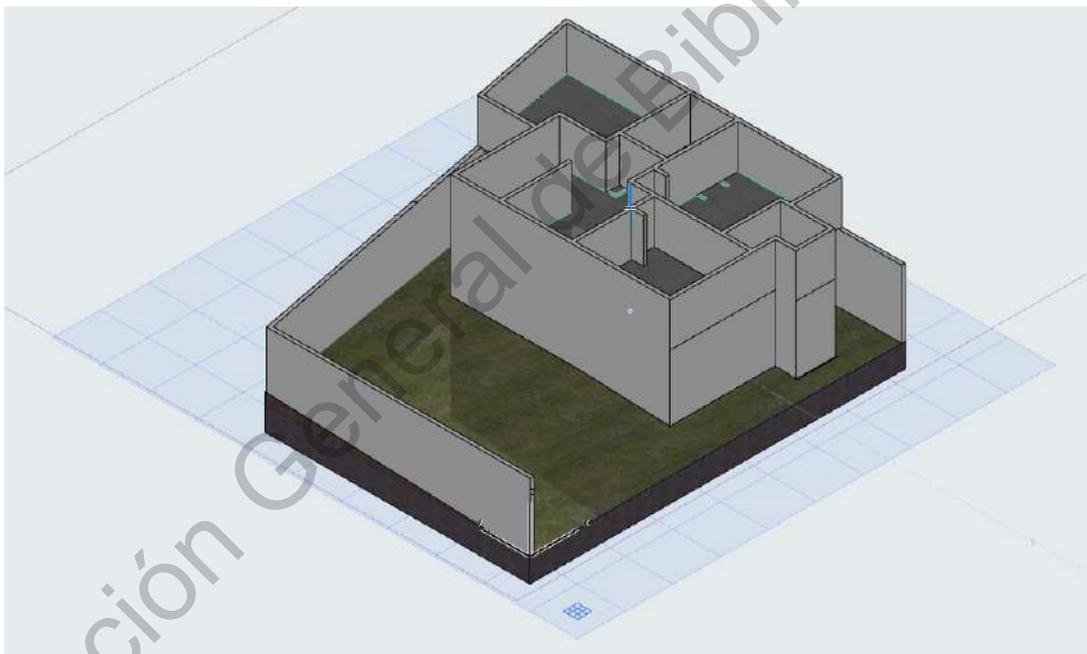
Suelos/Rampas de Planta alta del proyecto 001.
